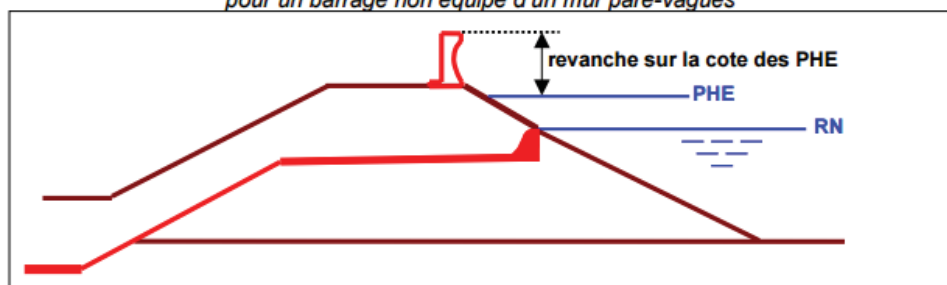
Revanche sur les PHE pour un barrage équipé d'un mur pare-vagues
